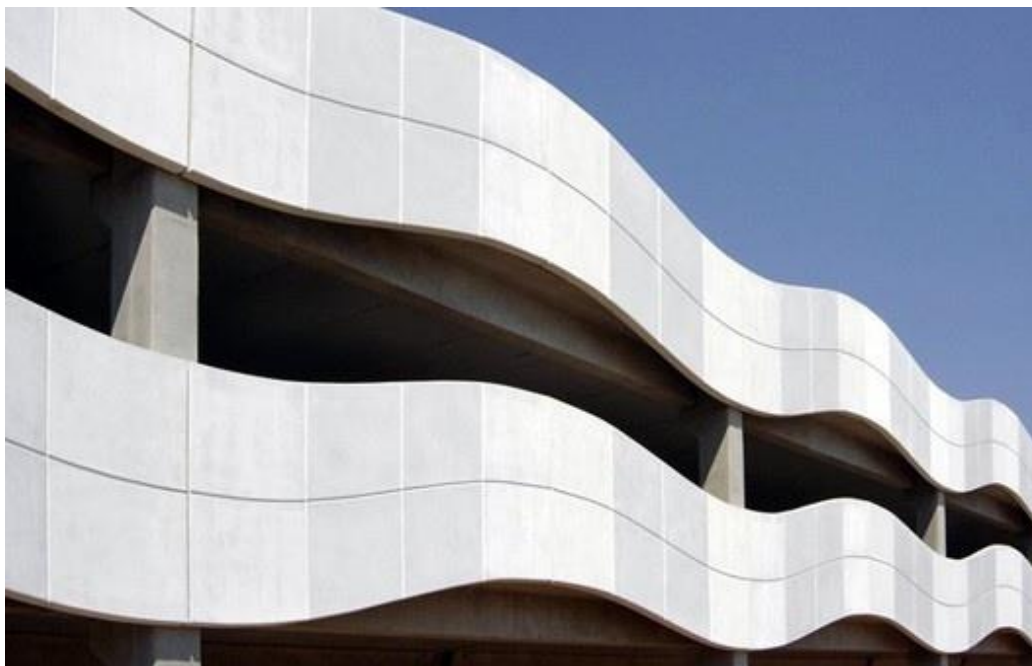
Sistema de junta e fixação de painel pré-fabricado de concreto
